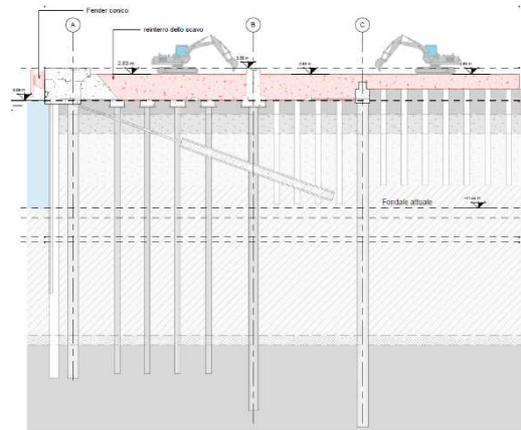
Sezione con indicazione dell'area di rinterro e installazione arredi di banchina.
